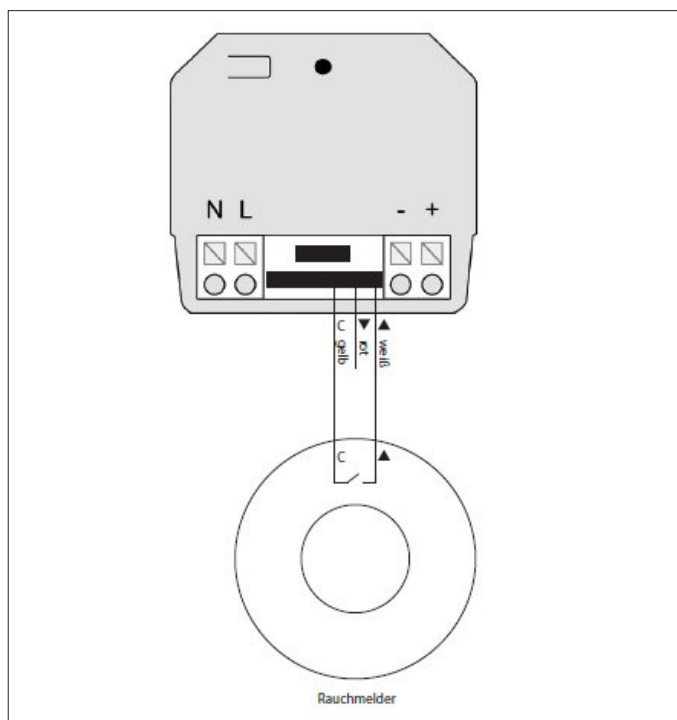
Anschlussskizze: Rauchmelder mit Schließkontakt
